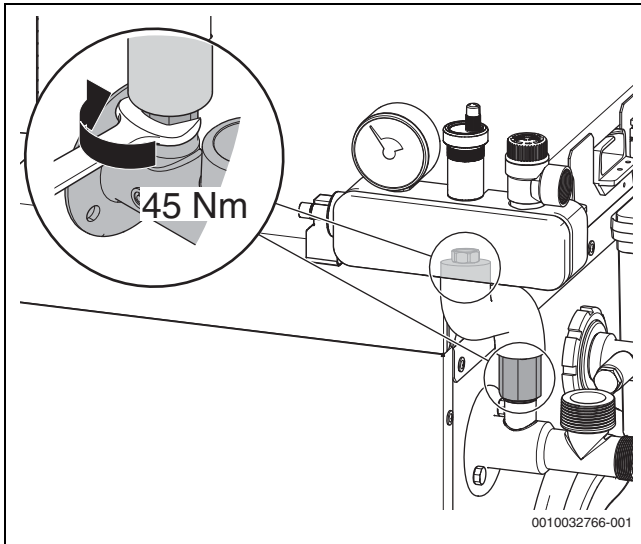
Kesselsicherheitsgruppe ausrichten (Beispiel)
